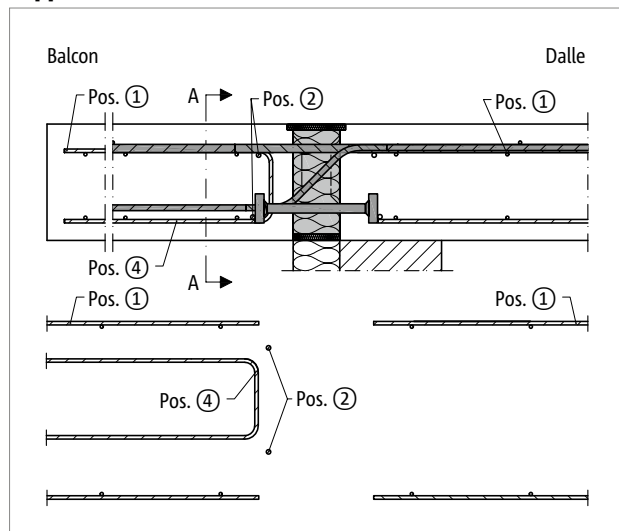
Schöck Isokorb® T Type K-M12 : Renforcement sur site pour support direct
